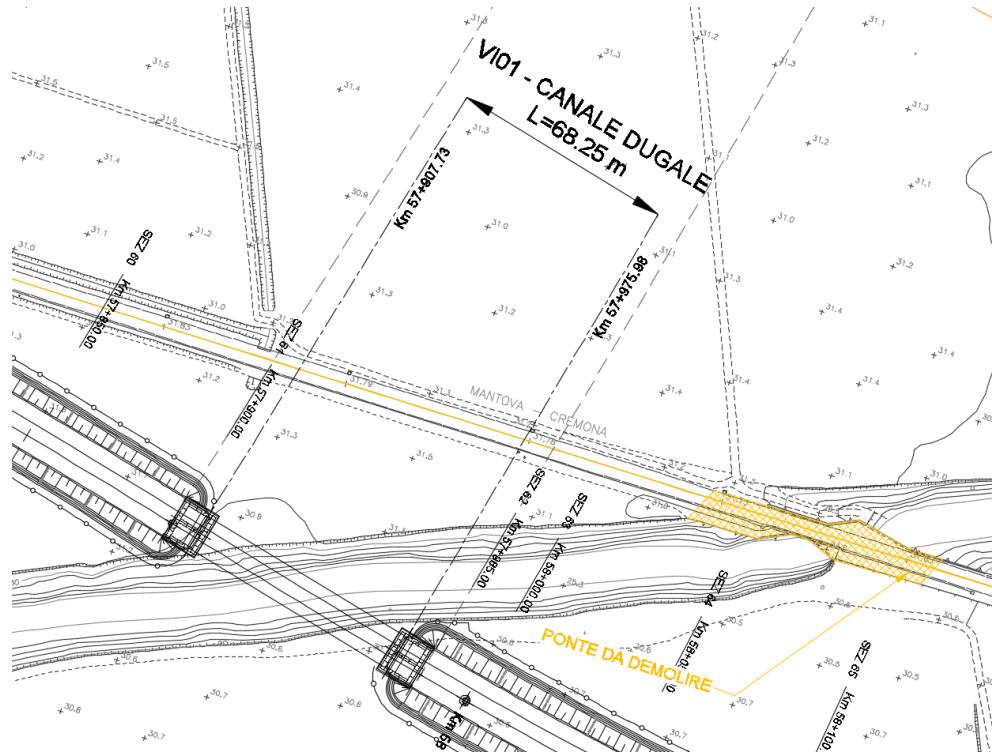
Opera di attraversamento in progetto sul Canale Dugale Tagliata (VI01): pianta.
